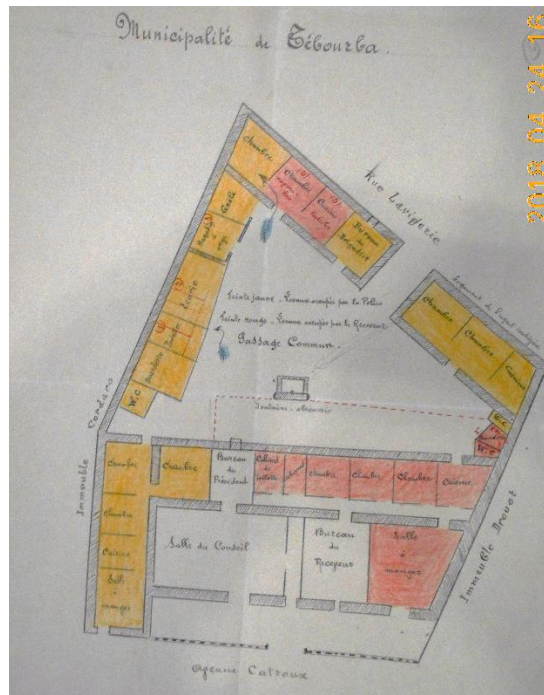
Plan du rez-de-chaussée de l'immeuble Carfort avant d'y installer la mairie de Tébourba⁵³.
